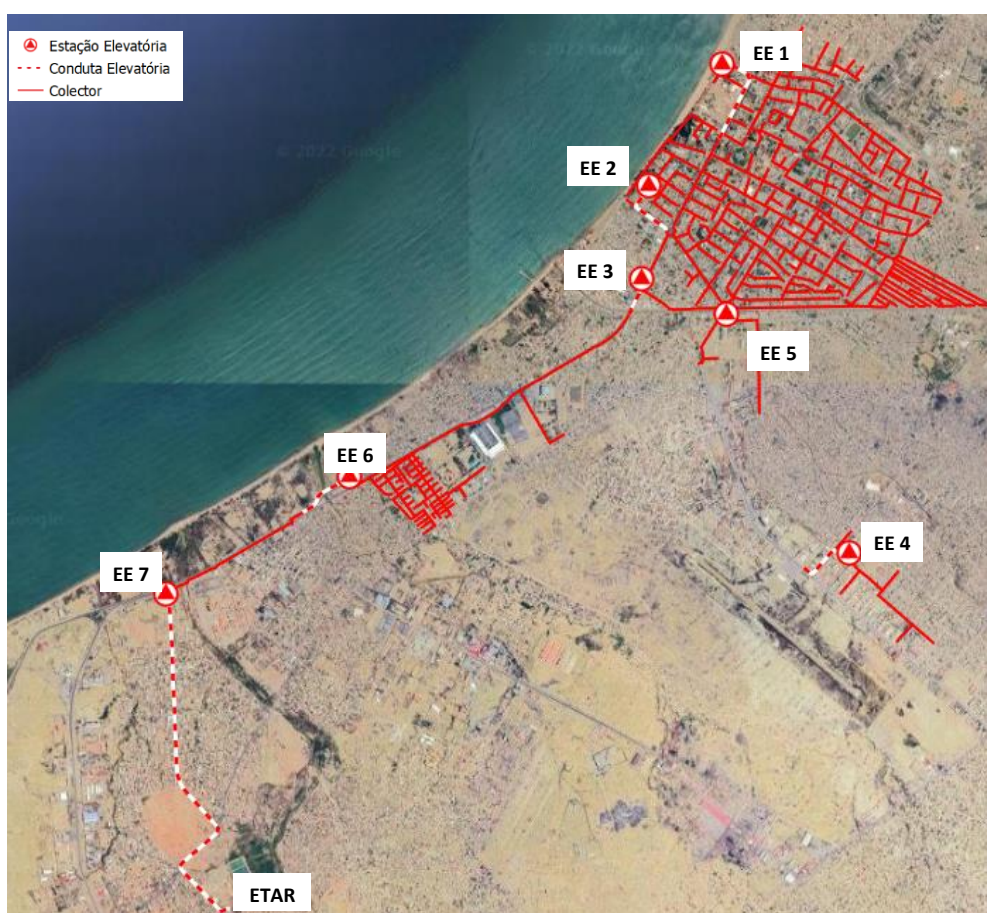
Representação esquemática das infra-estruturas de drenagem previstas
